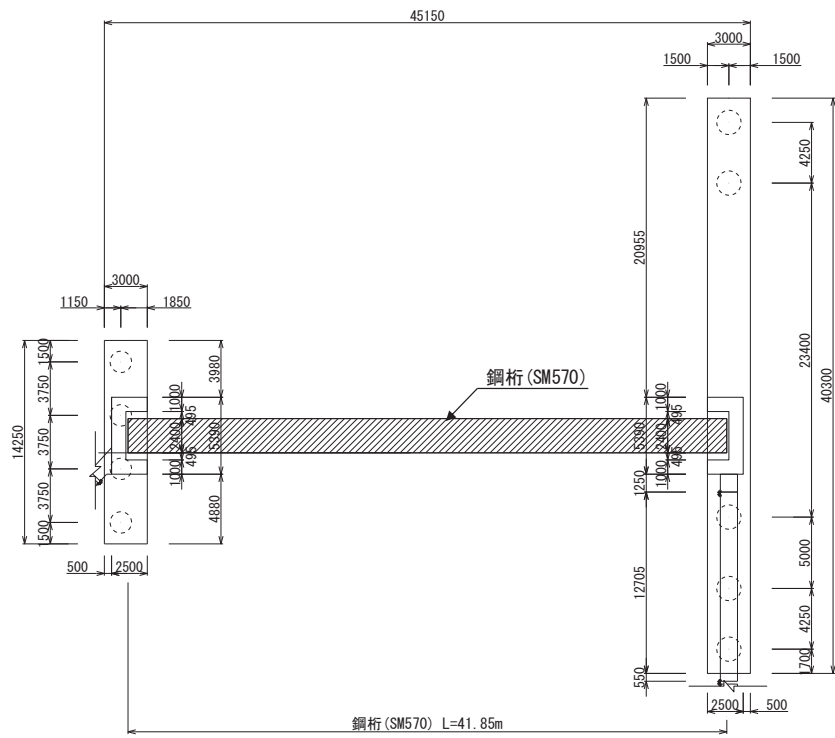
(2) 鋼製遮水壁（鋼桁 1） 平面図
